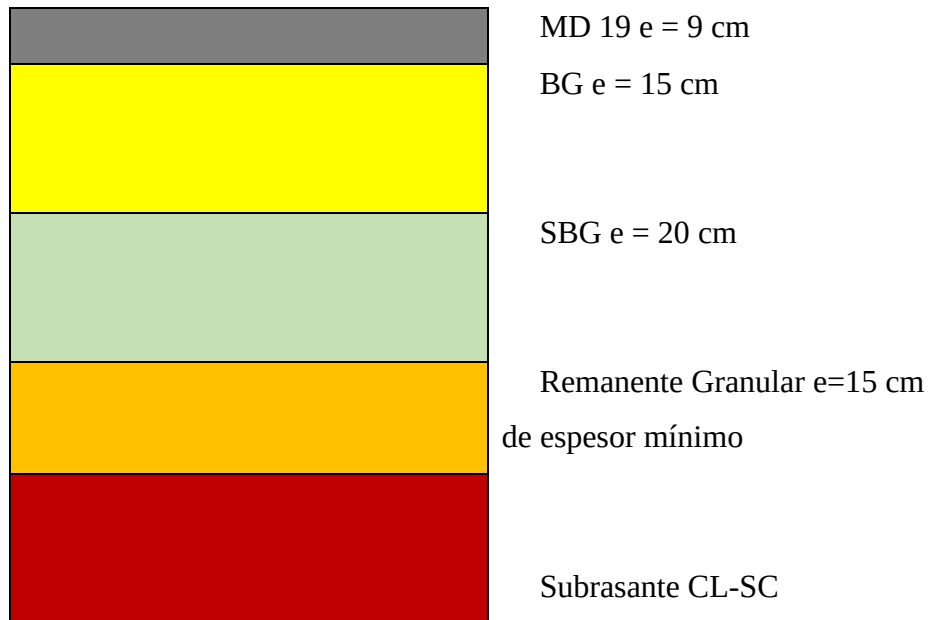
Perfil Vía Propuesto Pavimento Flexible
